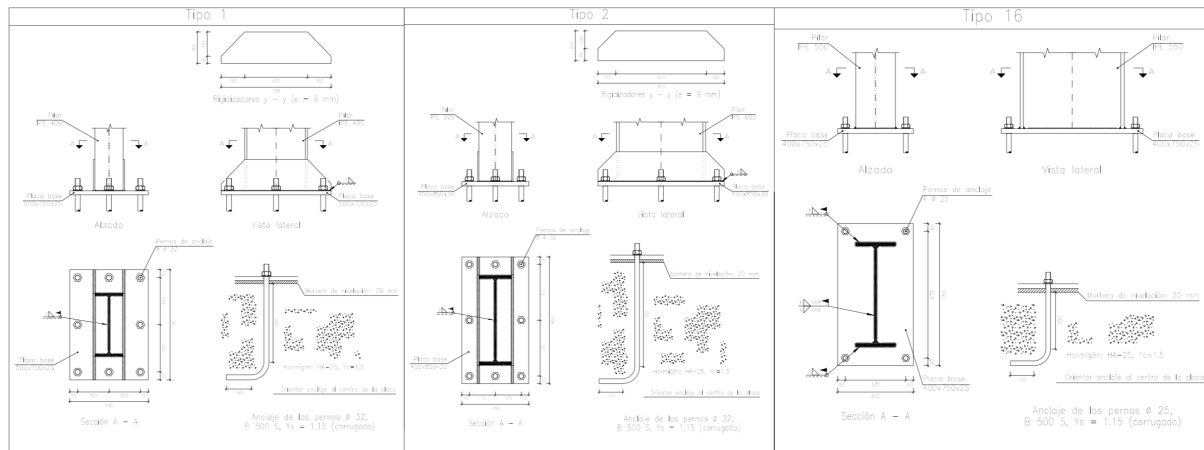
Tipologías de placa de anclaje instaladas en la nave
